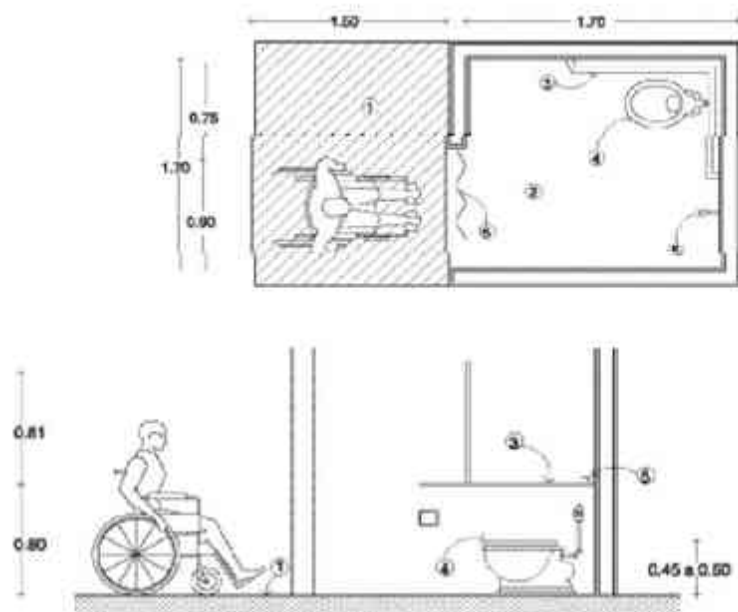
Alzado y planta de medidas para baños con personas que usan sillas de ruedas. <http://www.libreacceso.org>
